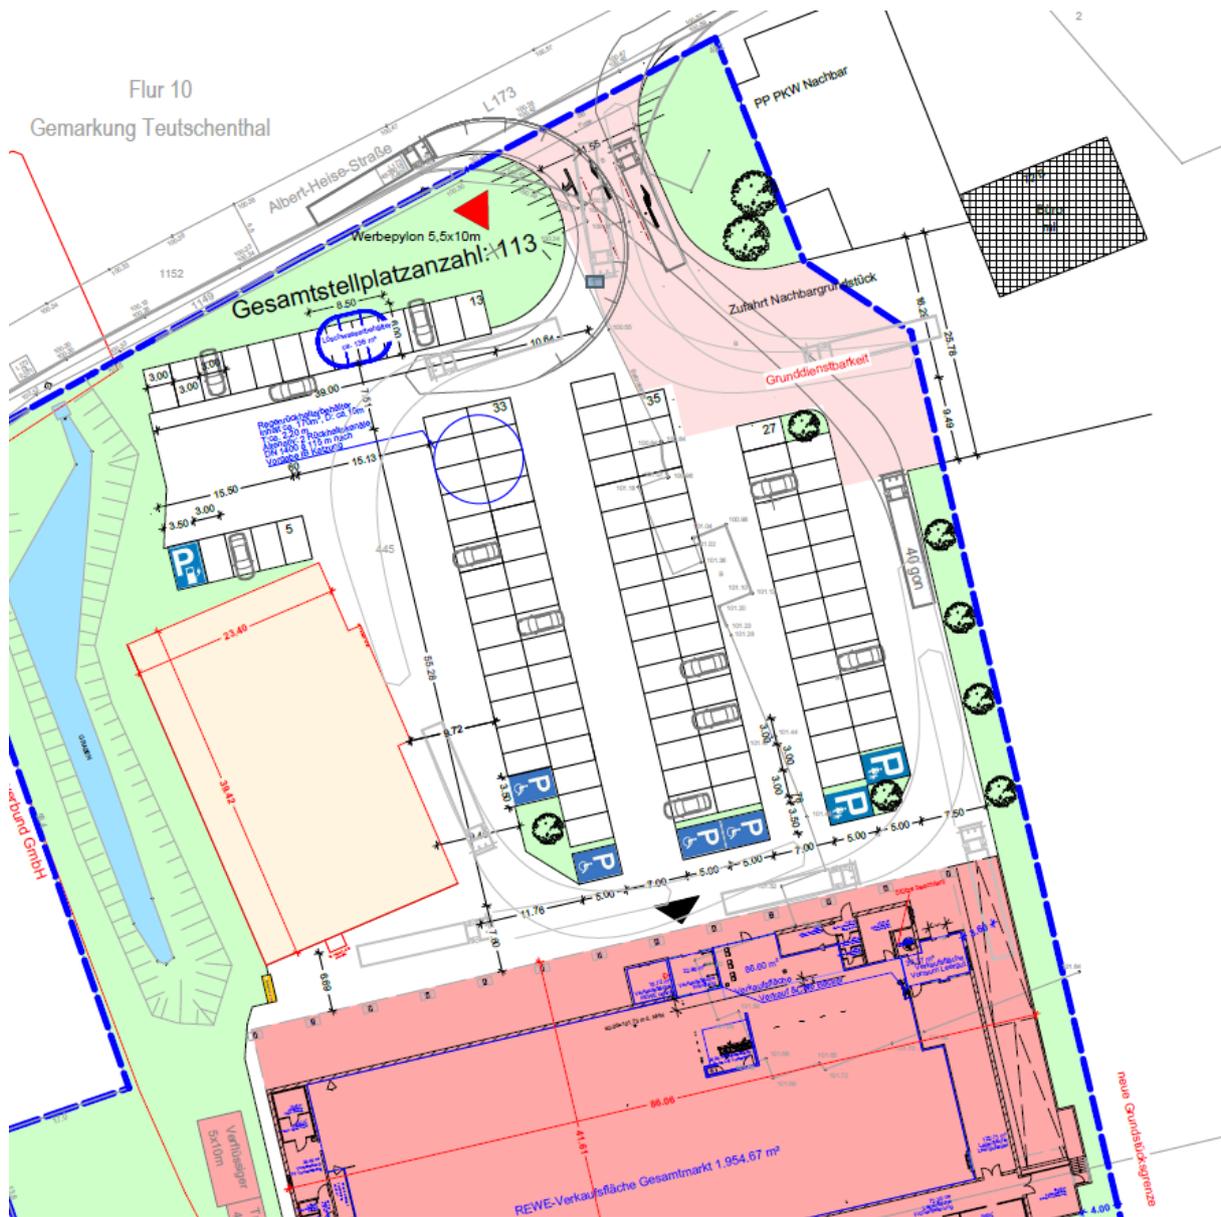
Auszug aus dem Lageplan zur Objektplanung (Entwurf: Dipl.-Ing. Michael Jope, Weimar (Stand: 15.12.2021)) – unmaßstäblich
